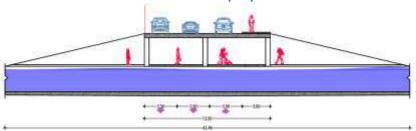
Sección vial con proyecto Calle 5 de Mayo
